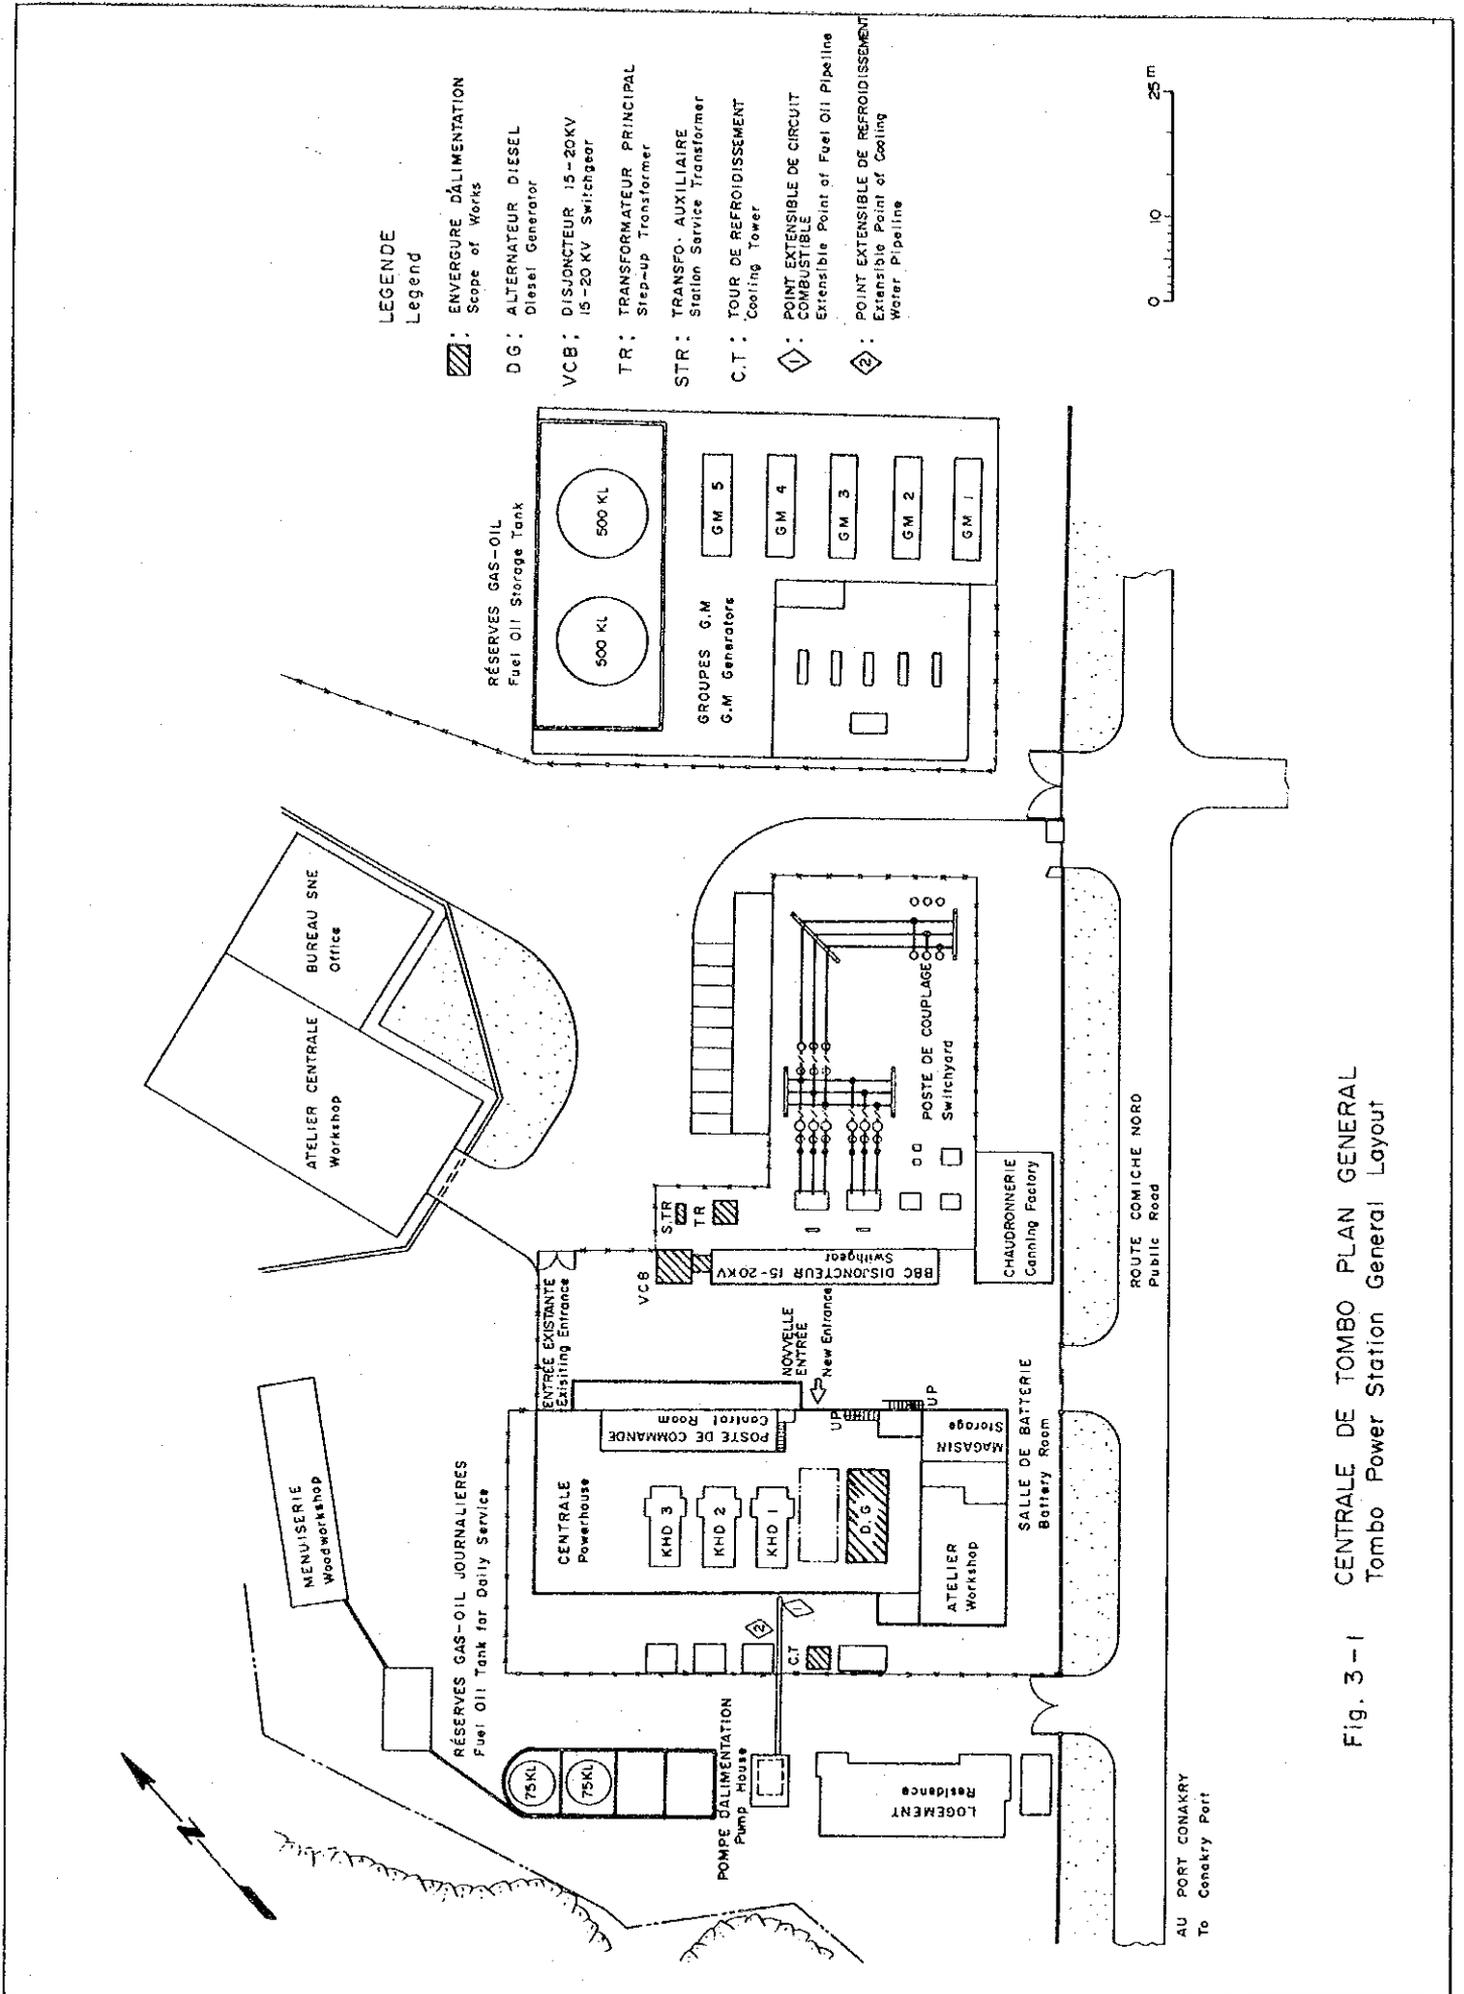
CENTRALE DE TOMBO PLAN GENERAL
